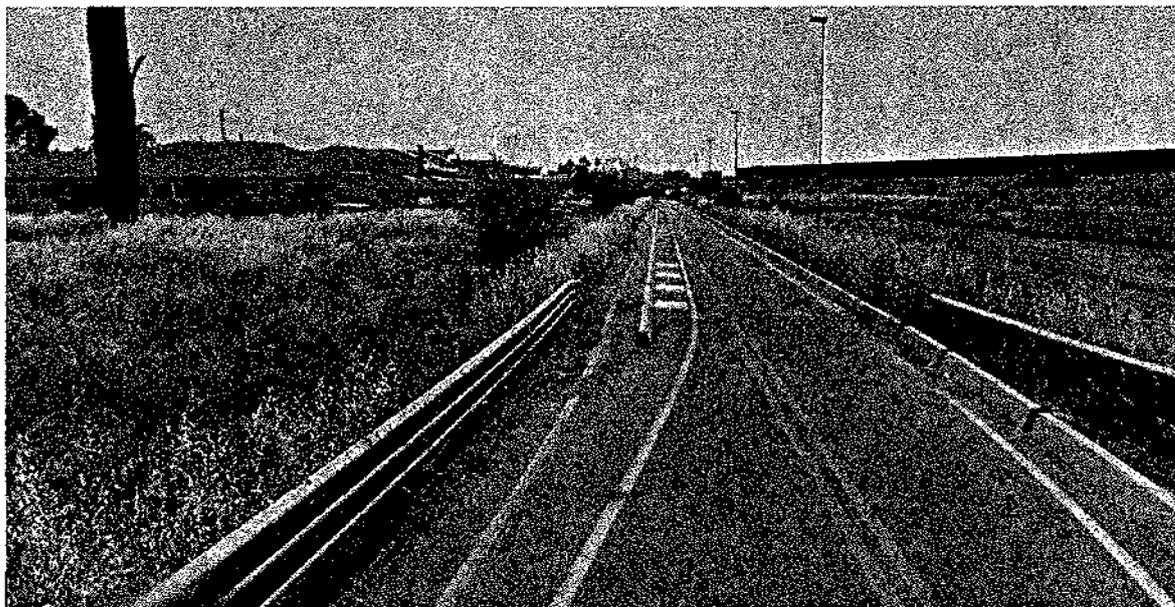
VISTA DEI TERRENI LUNGO LA VIA DI MACCIONE
